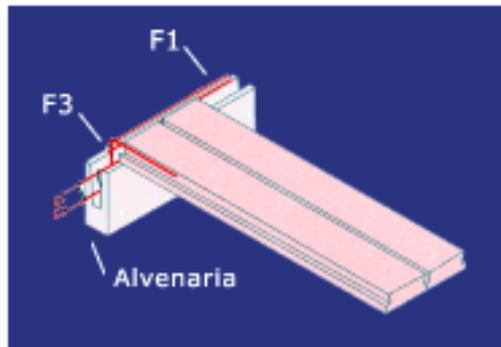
Detalhe da ligação entre os painéis de laje e a alvenaria Sical
